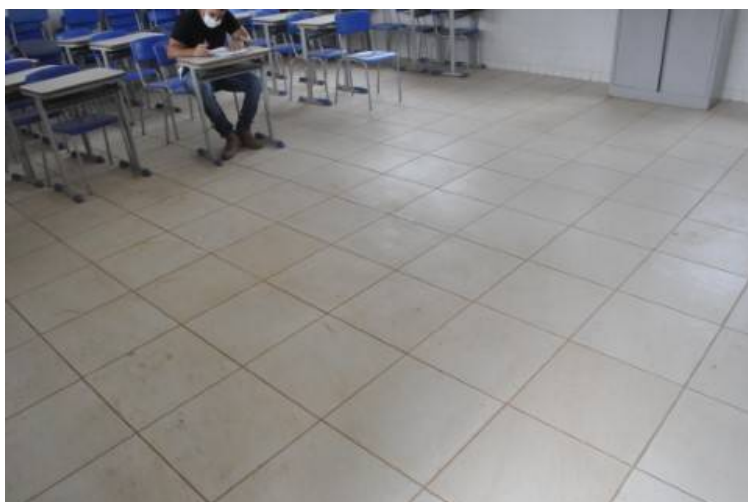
Vista geral: Piso da sala de aula 01.
